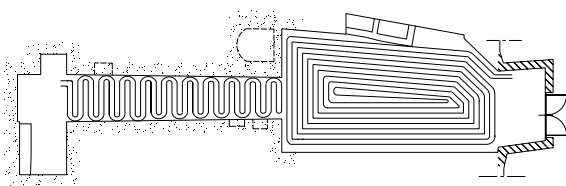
disposizione delle tubazioni per il riscaldamento a pavimento
